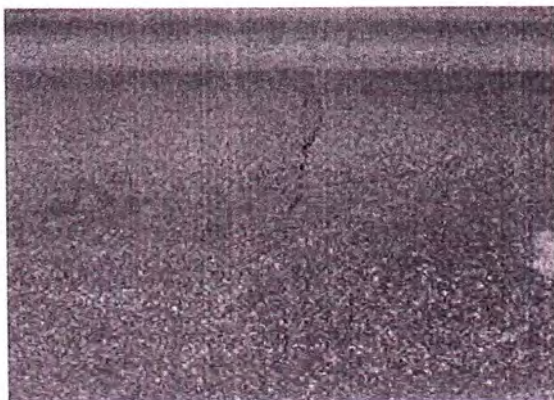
Grieta longitudinal y transversal severidad alta
